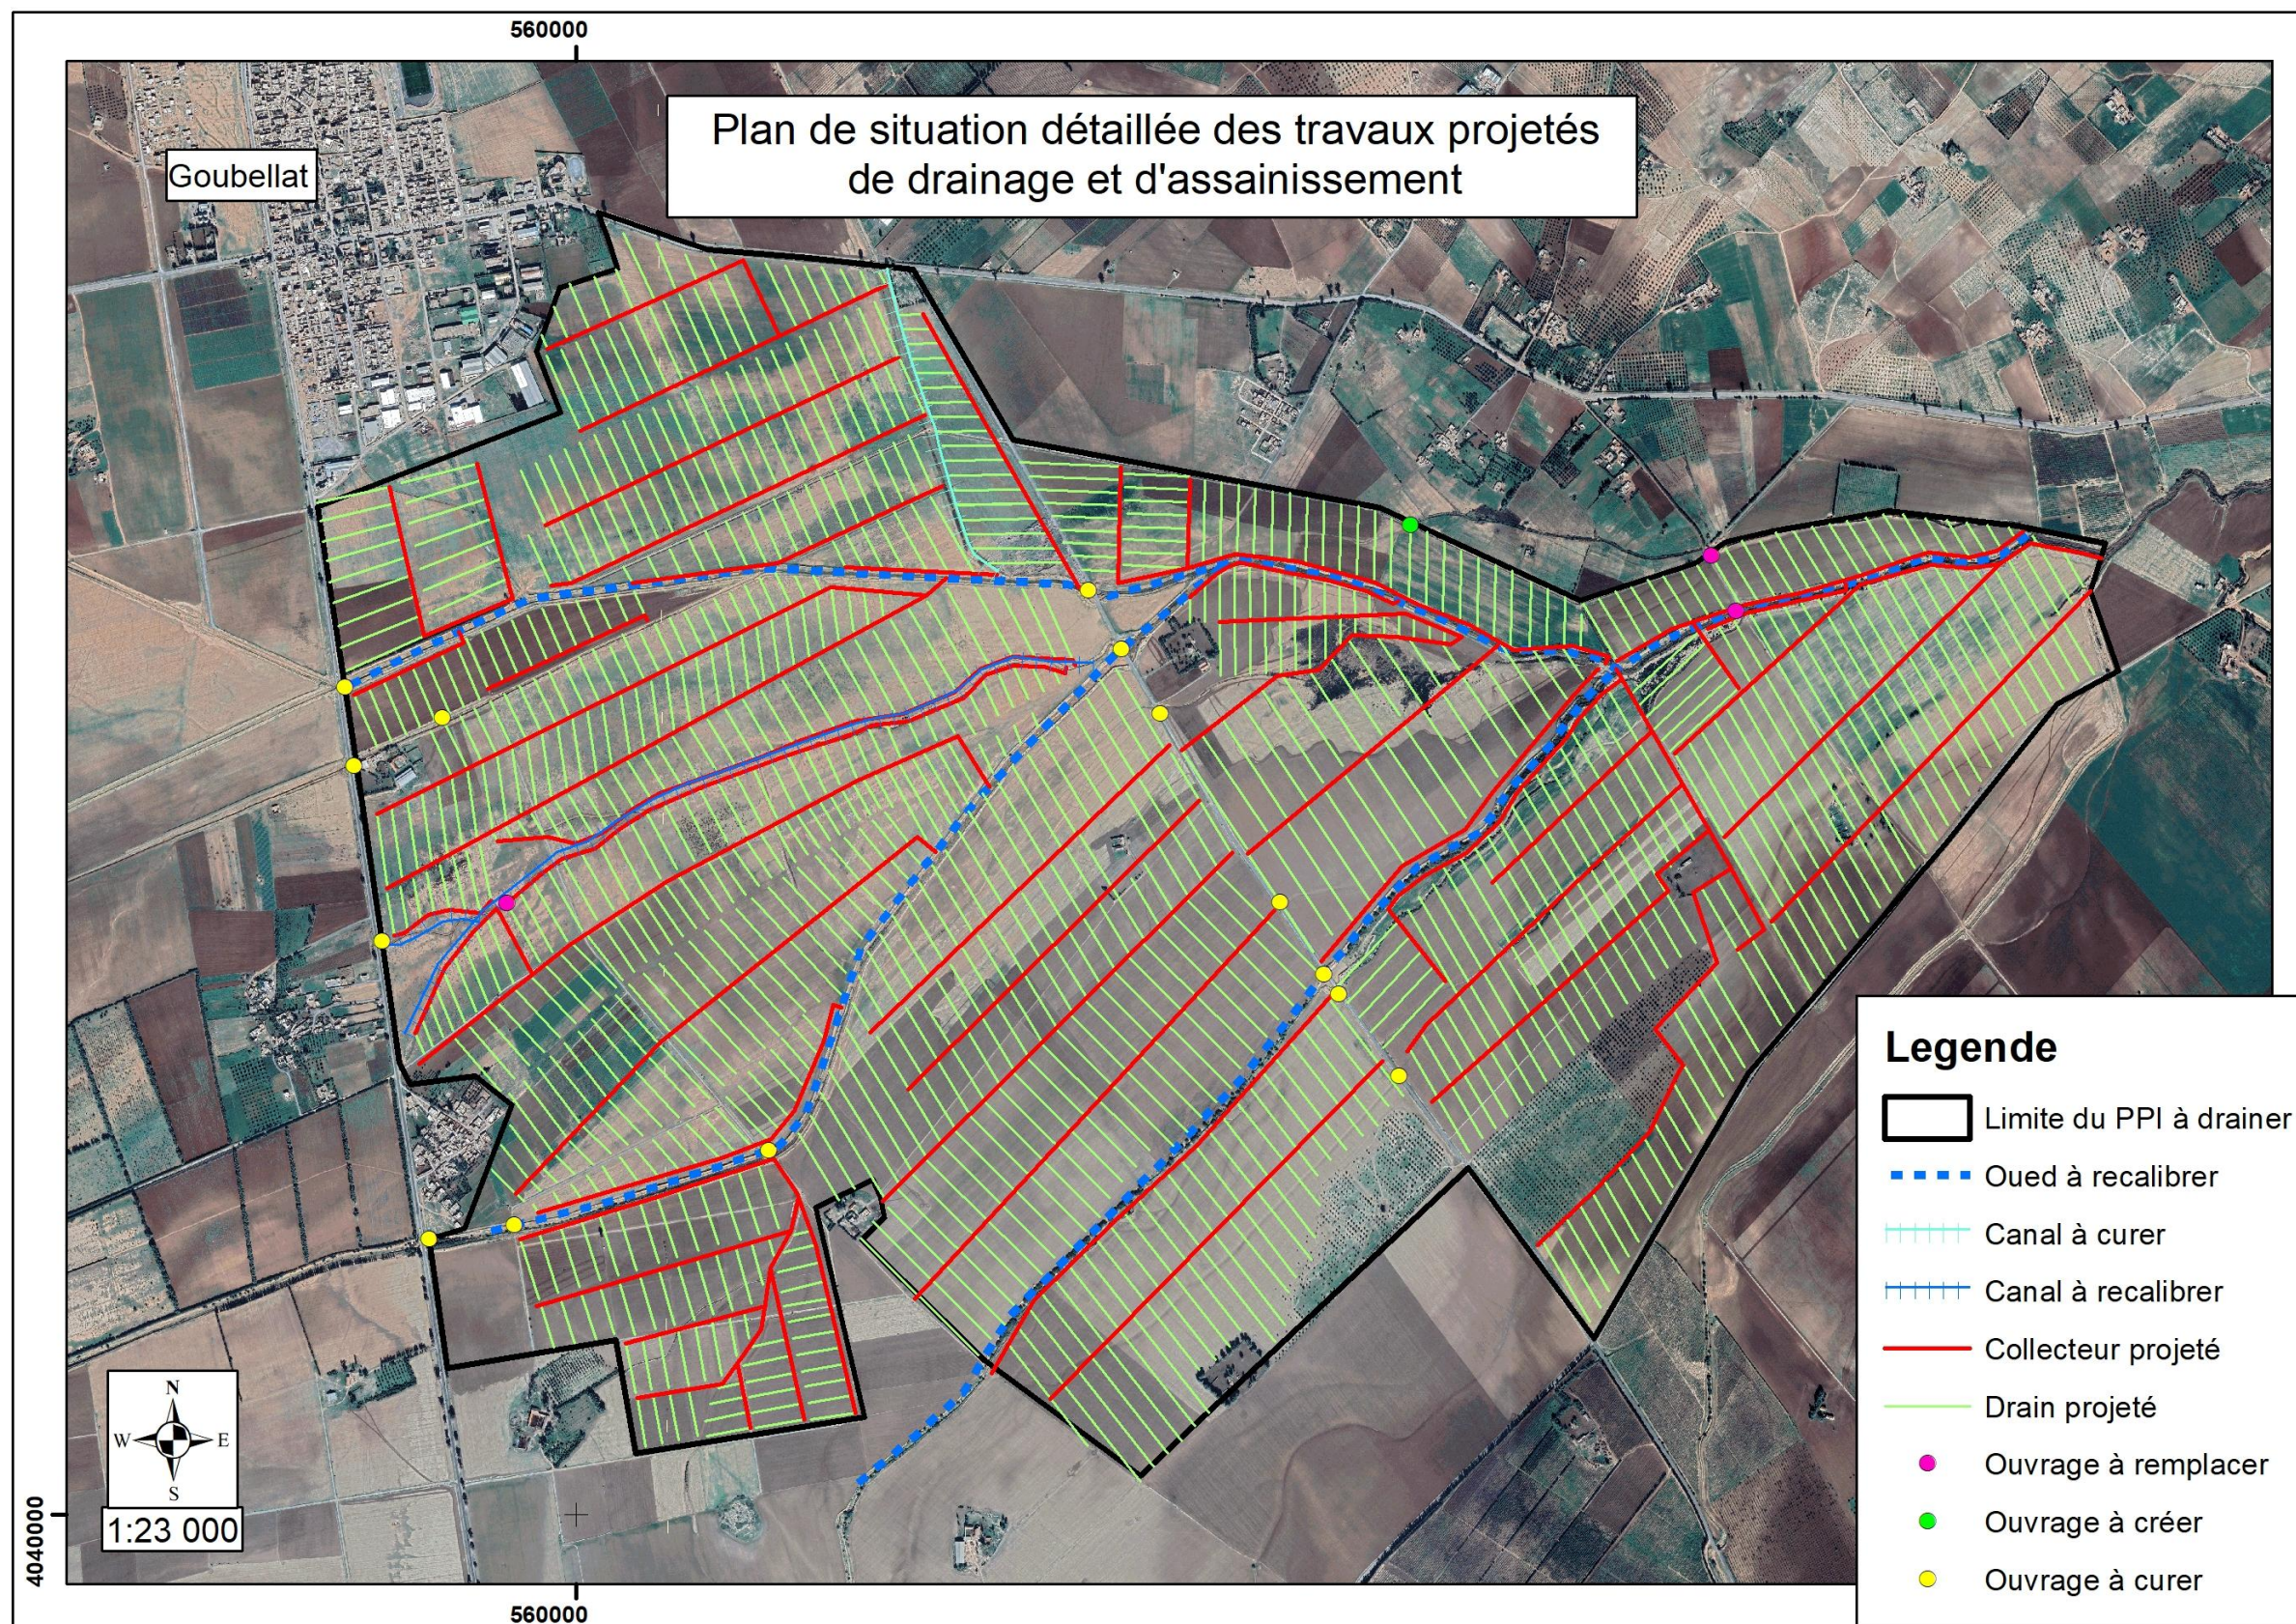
Plan de situation des travaux d'assainissement et de drainage
